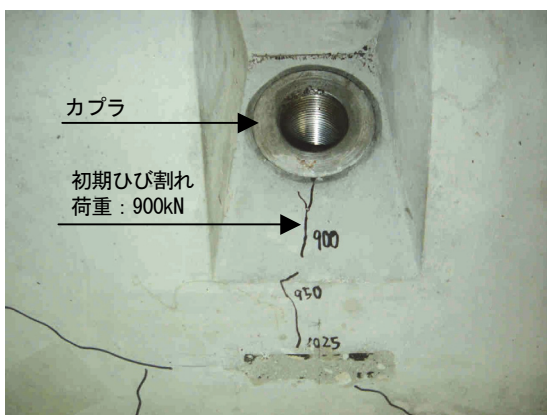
アンカー近傍のひび割れ発生状況 (本実験)
